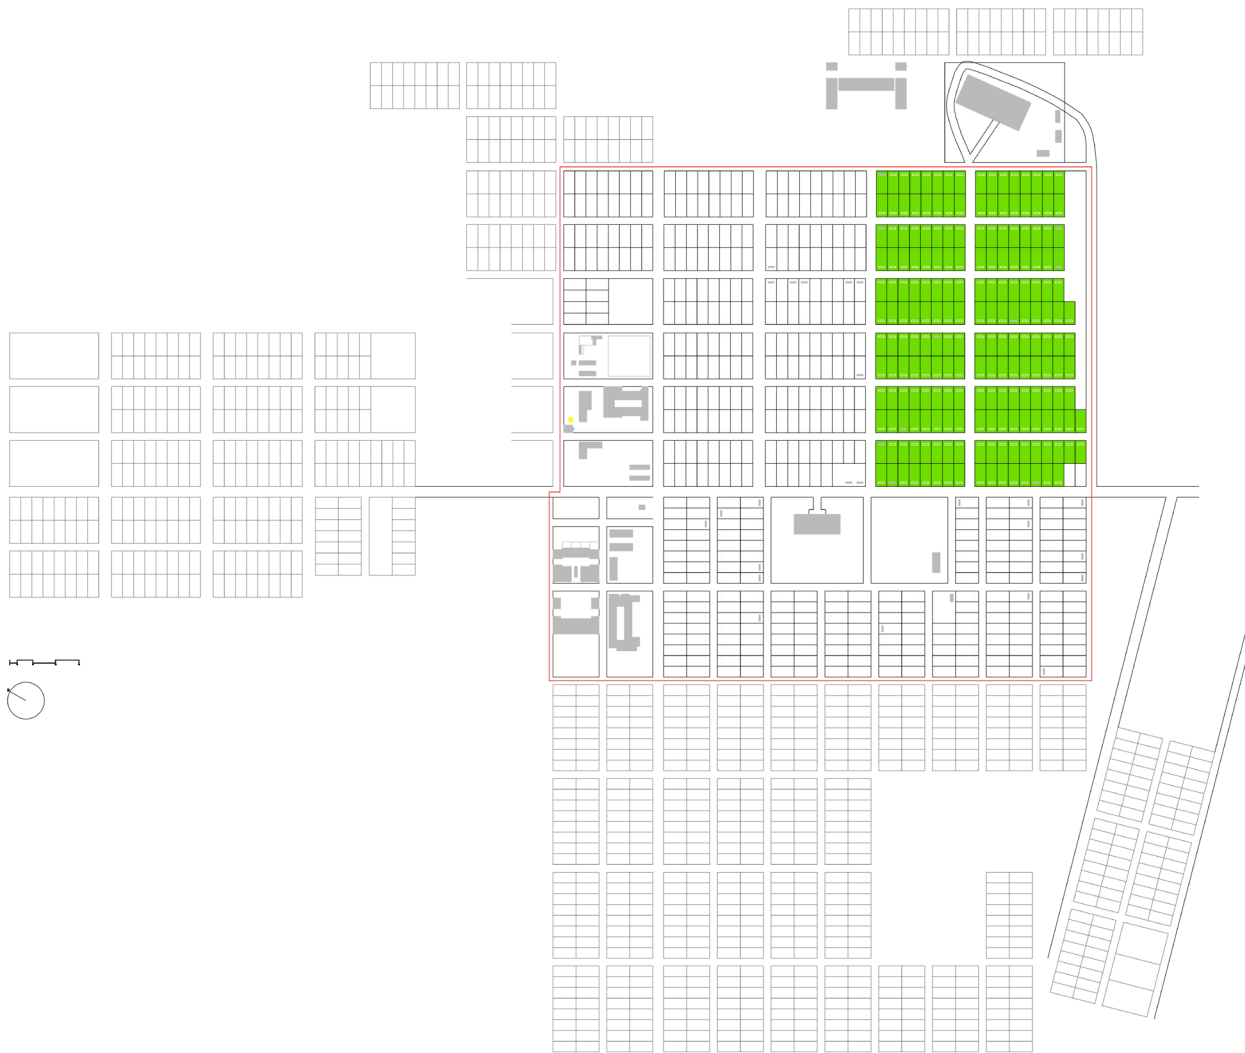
Segundo período de construção da primeira fase, entre 2002 e 2003.(ver em anexo planta com legendas e outras fases).
